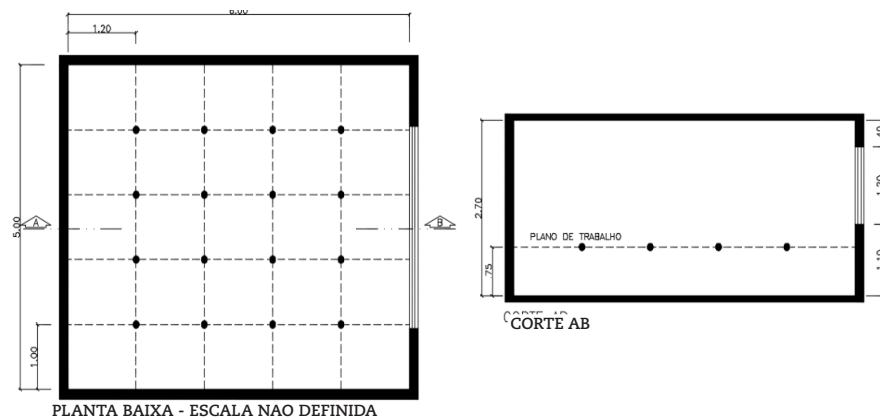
Planta baixa e Corte AB esquemáticos do ambiente interno com abertura lateral.
